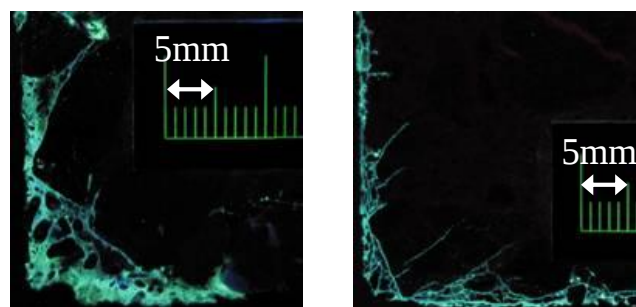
ひび割れの観察 (FB: 凍結融解試験)
